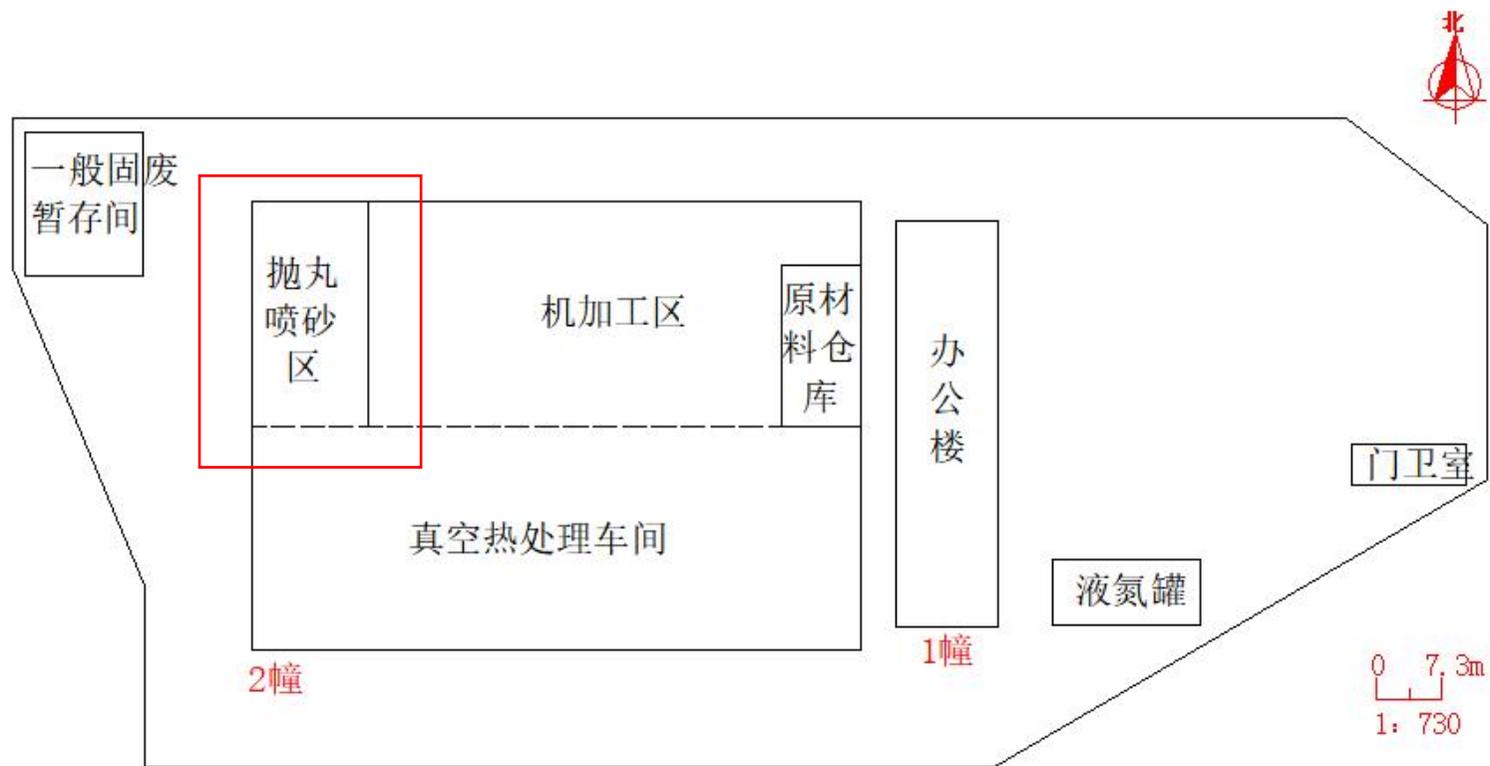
项目厂区平面图（红色方框为本次验收范围）
